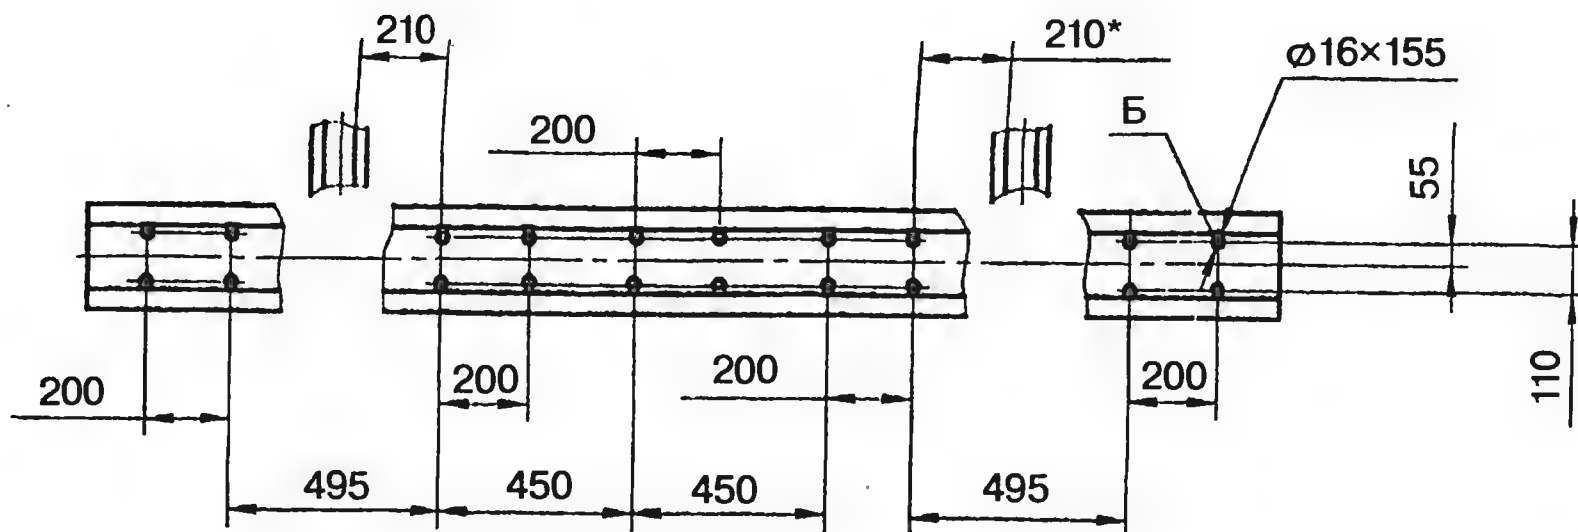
Монтажный чертеж УКСПС-1520-Р50
